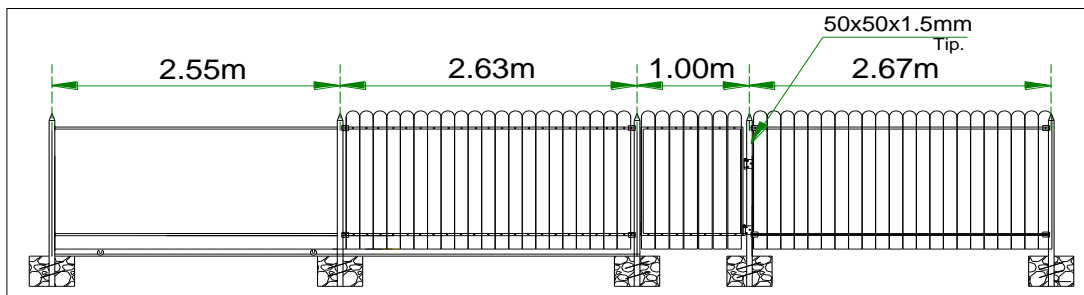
Detalle de Distancia de Pilares c) Fuente: Propia
